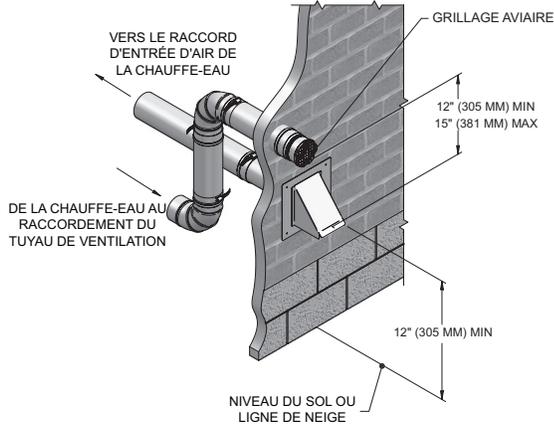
B Terminaison latérale en PVC/CPVC alternative d'air et de ventilation, avec raccords fournis sur place
